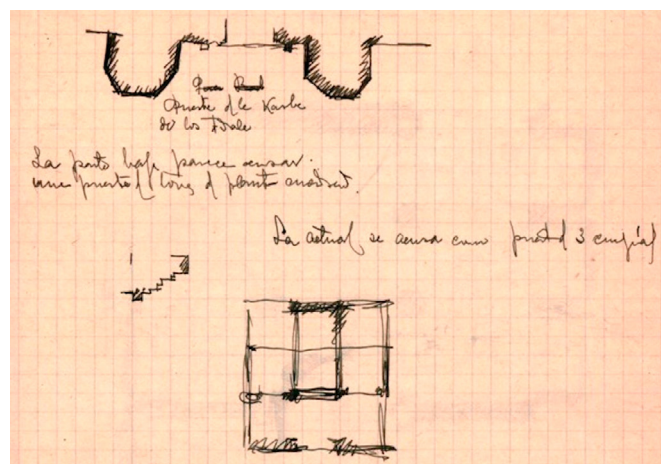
Puerta de la Qaṣba de los Filāla, Fez. Croquis de la planta (FH_8_04_001_023d). © MAP, Córdoba.
